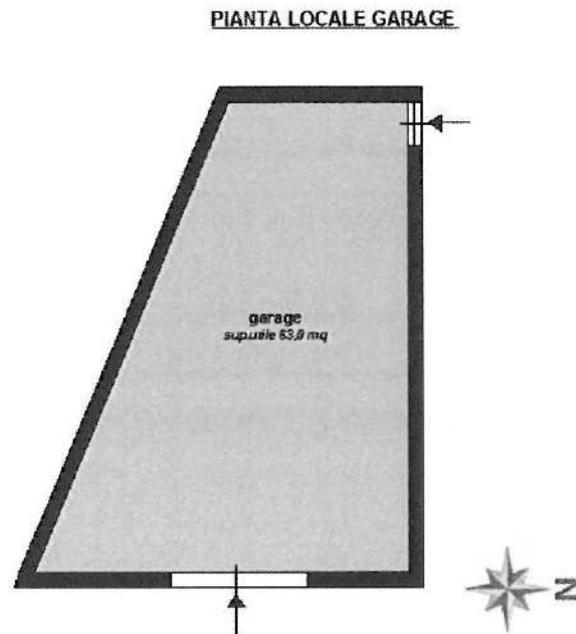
PIANTA LOCALE GARAGE-STATO ATTUALE
